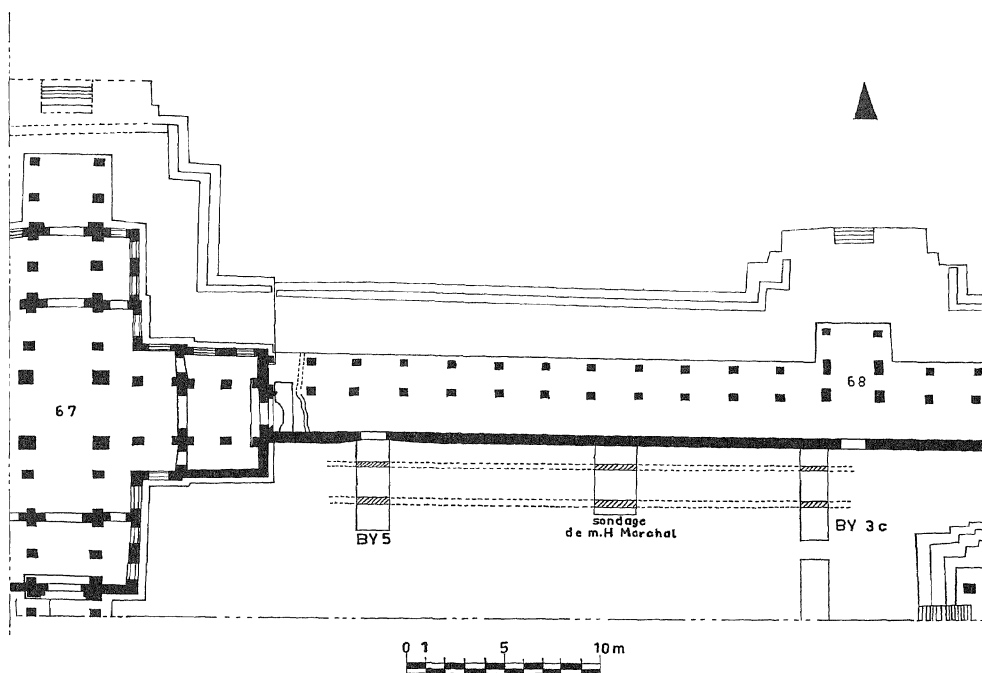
Plan de situation des sondages ouverts le long du mur aux bas-reliefs de la galerie du premier étage, face Nord, aile Est.
